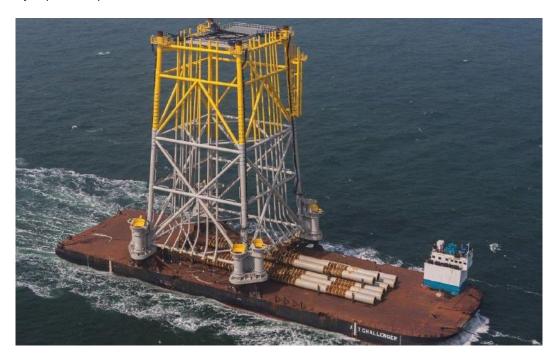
Exemple de transports de pieux et de la sous structure sur une barge. Source : DNV
